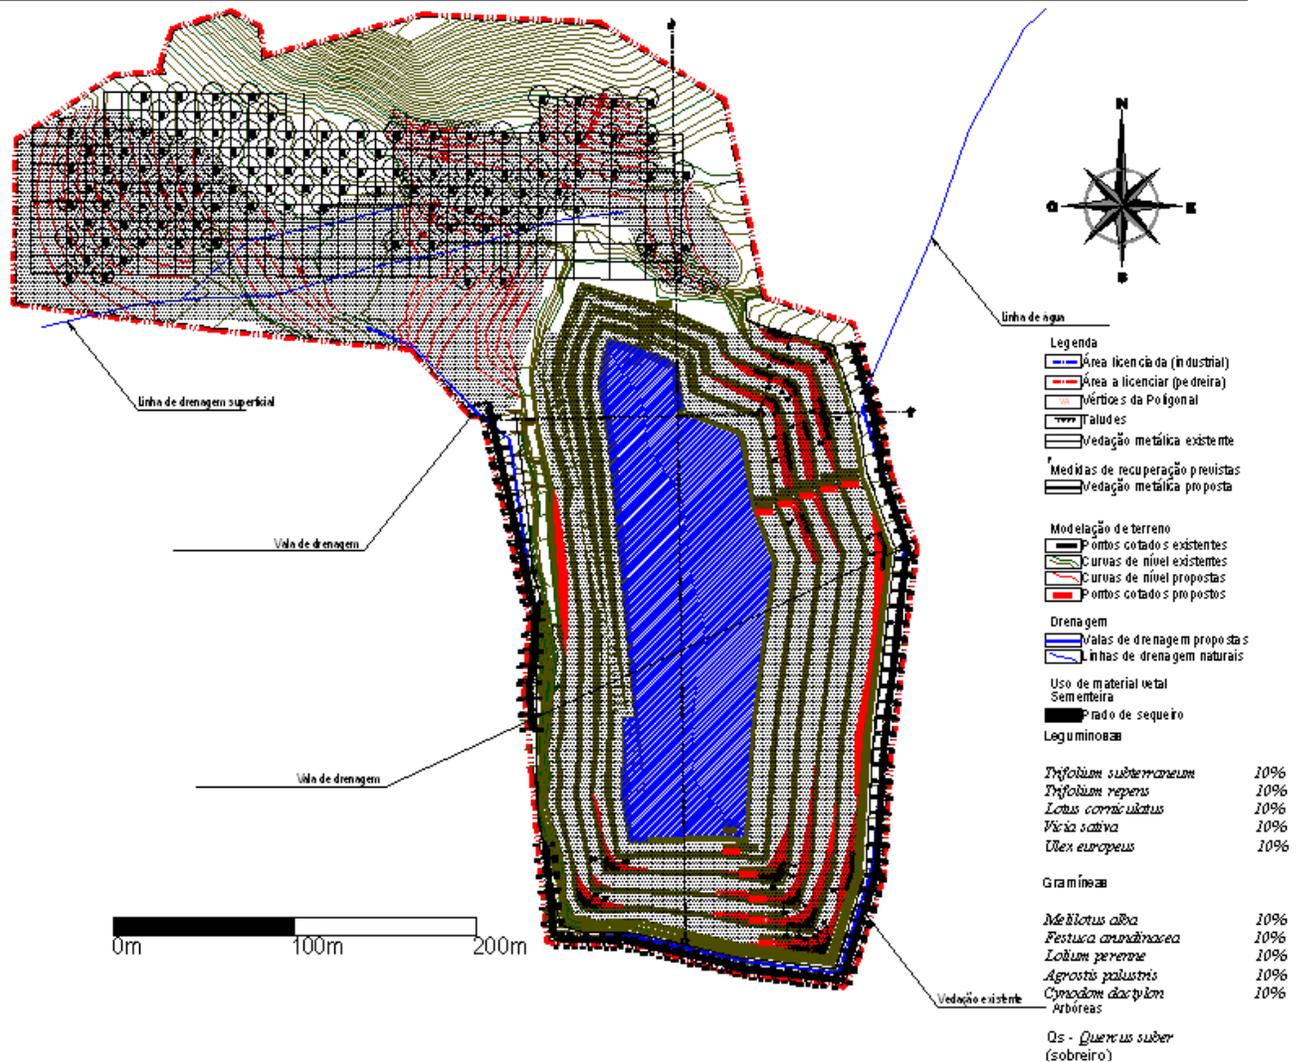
Planta Final de recuperação paisagística da pedreira “Quinta do Derramado”.
